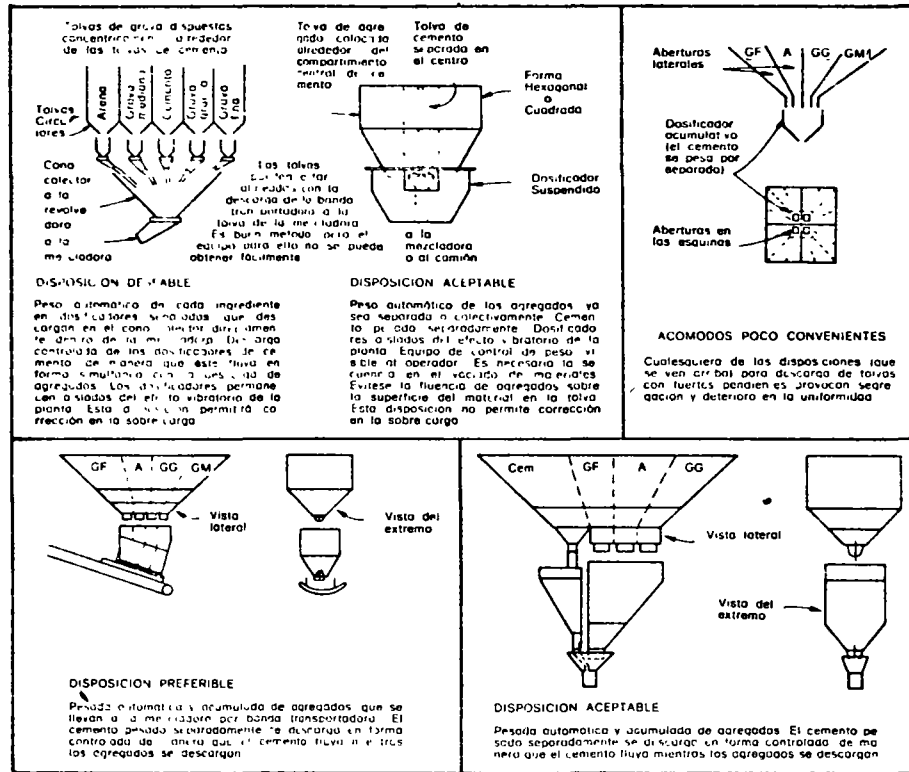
Disposición de las tolvas en la planta de concreto.
